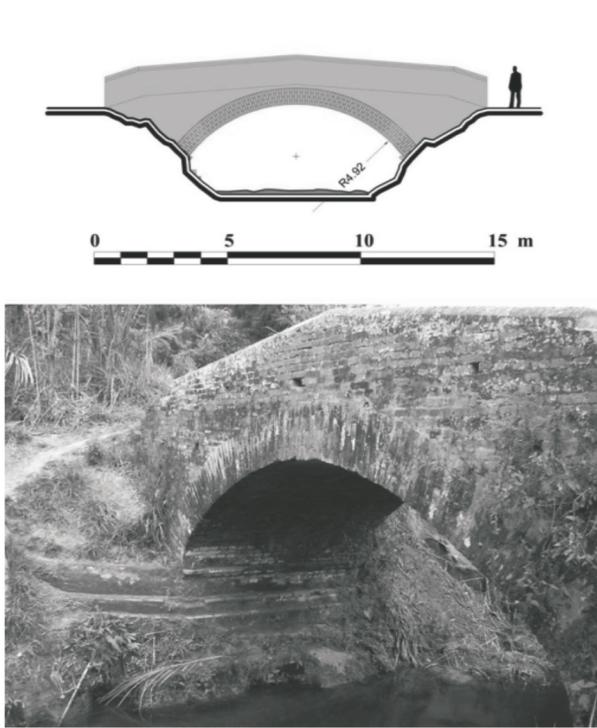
Alzada y fotografía reciente del puente sobre el río Pescador, entre Popayán y Cali (1891).
